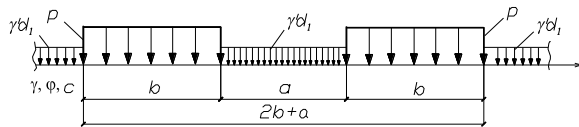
Розрахункова схема взаємодії фундаменту з ґрунтовою основою
